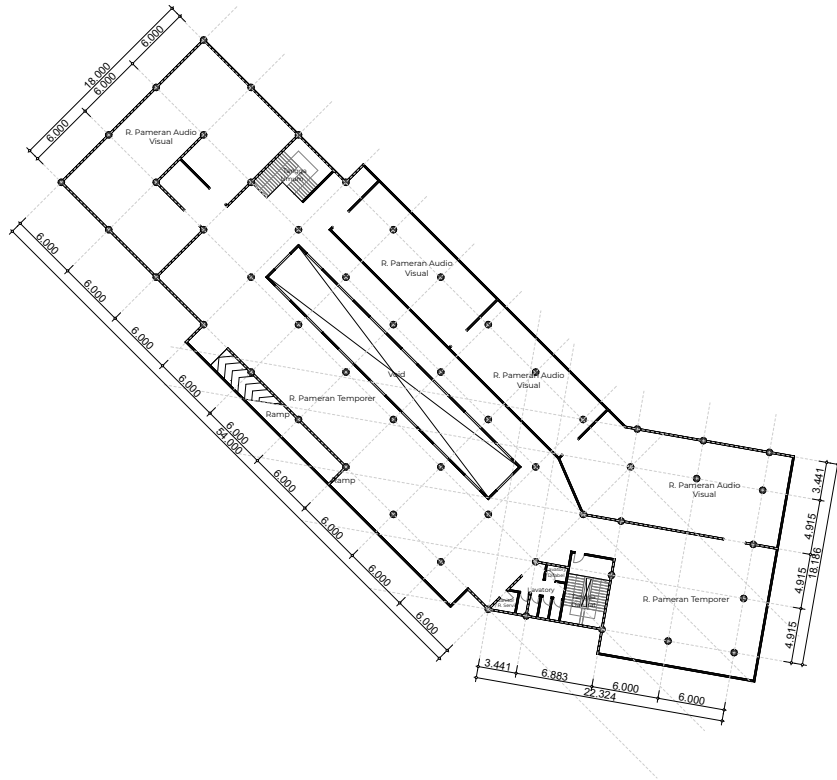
Denah Lt.1 Alternatif 1 dan 2
